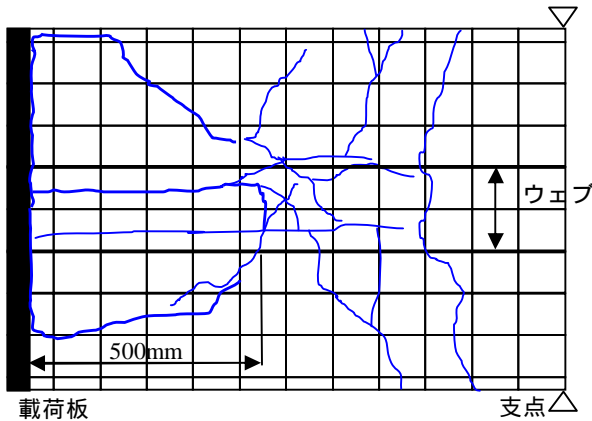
No. 3 フランジ上面ひび割れ図 (実験終了時)
